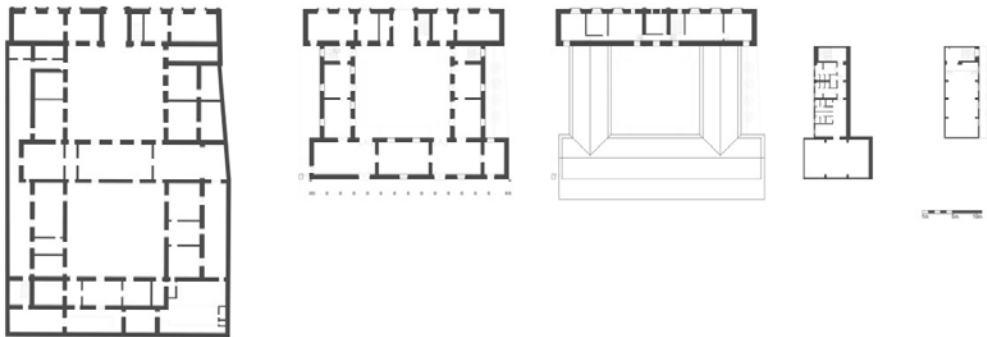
Planimetría de la Casa Colorada. De izquierda a derecha planimetría original y planimetría actual 1º piso, 2º piso y piso subterráneo. Elaboración propia.
